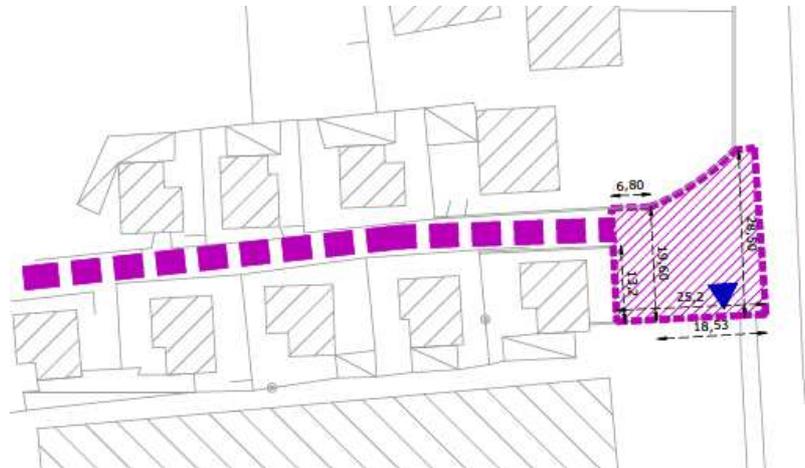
Particolare intervento A Strada chiusa e parcheggio
